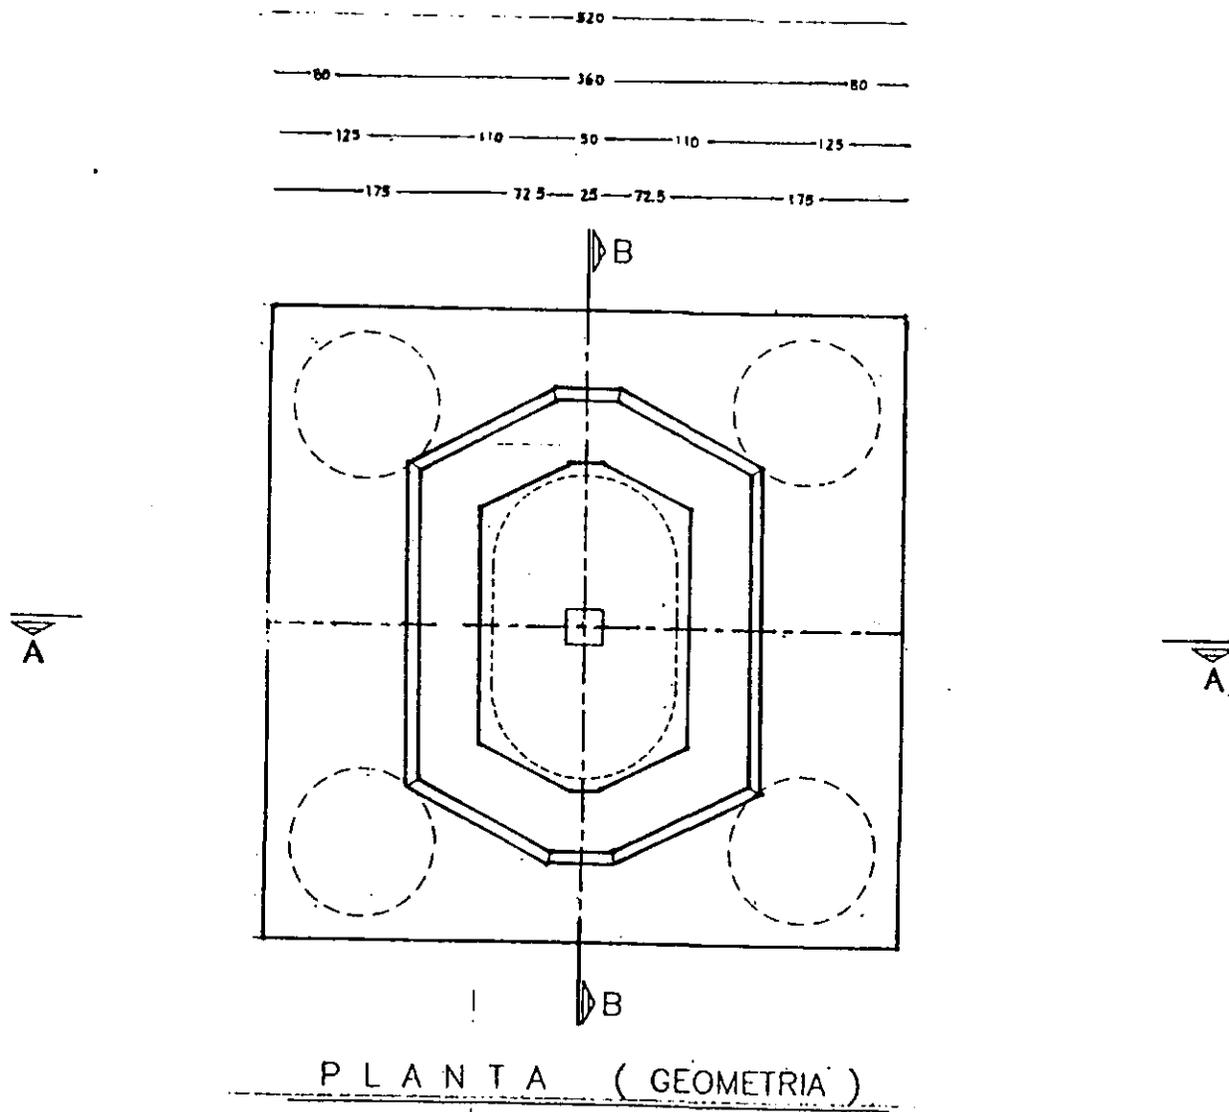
B. Vista en Planta De Una Zapata de Cimentación.
